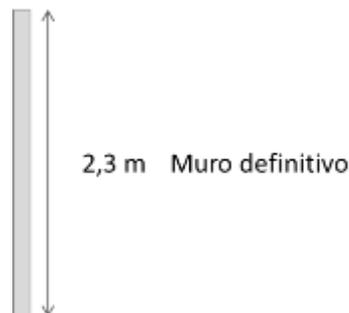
Cierre perimetral propuesto para costado oriente del proyecto.
